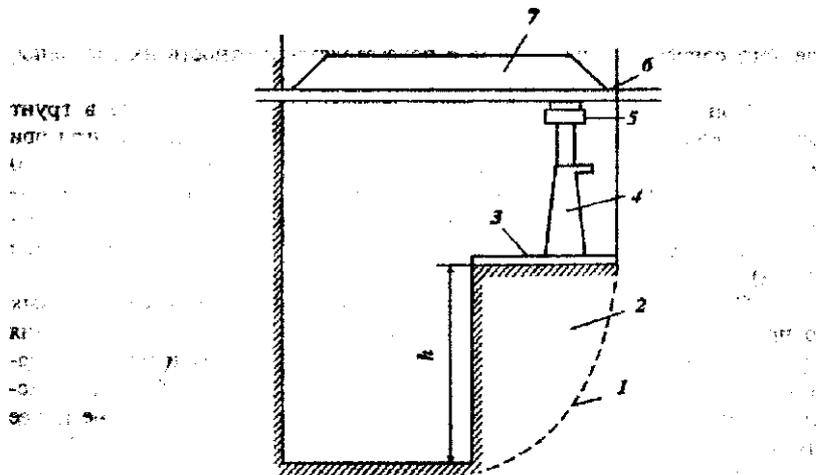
Схема установки для проведения испытаний грунта на сдвиг обрушением:
